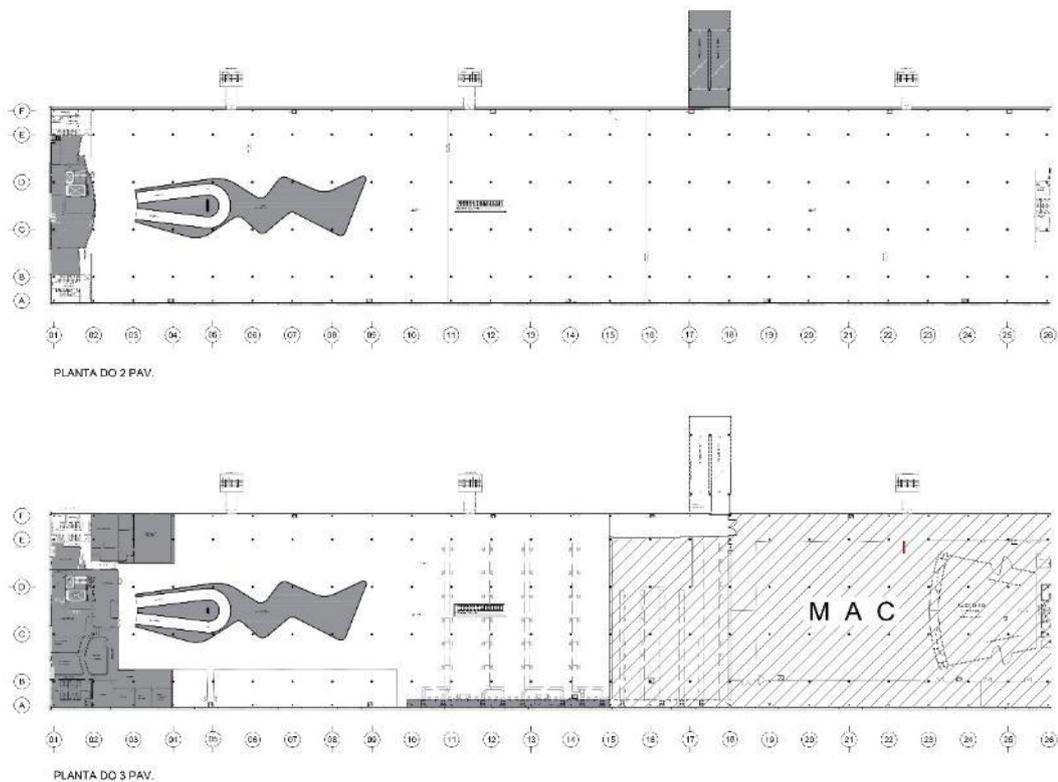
Plantas do segundo e terceiro pavimentos do Pavilhão Bienal | São Paulo
